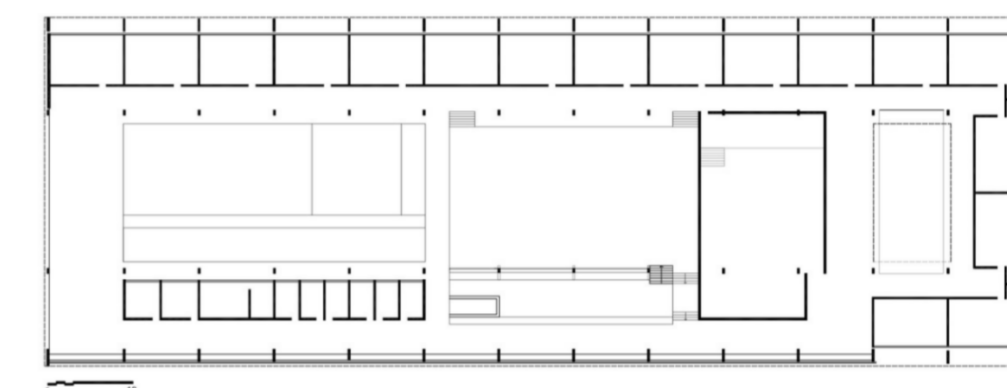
Escola de Garulhos, Vilanova Artigas - Planta
